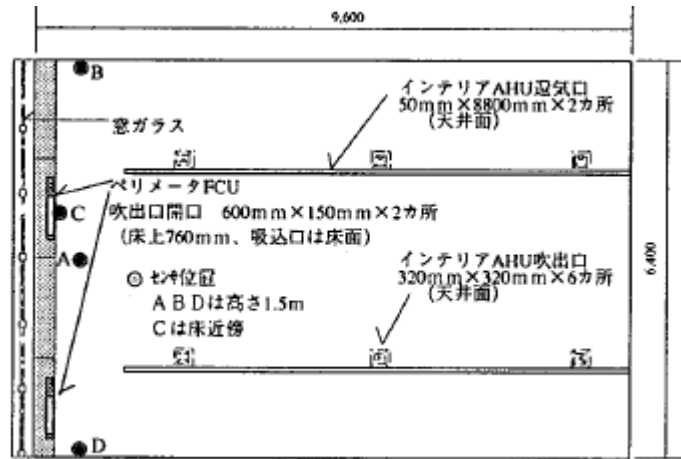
実験室内解析モデル概要 (平面) 文5)
